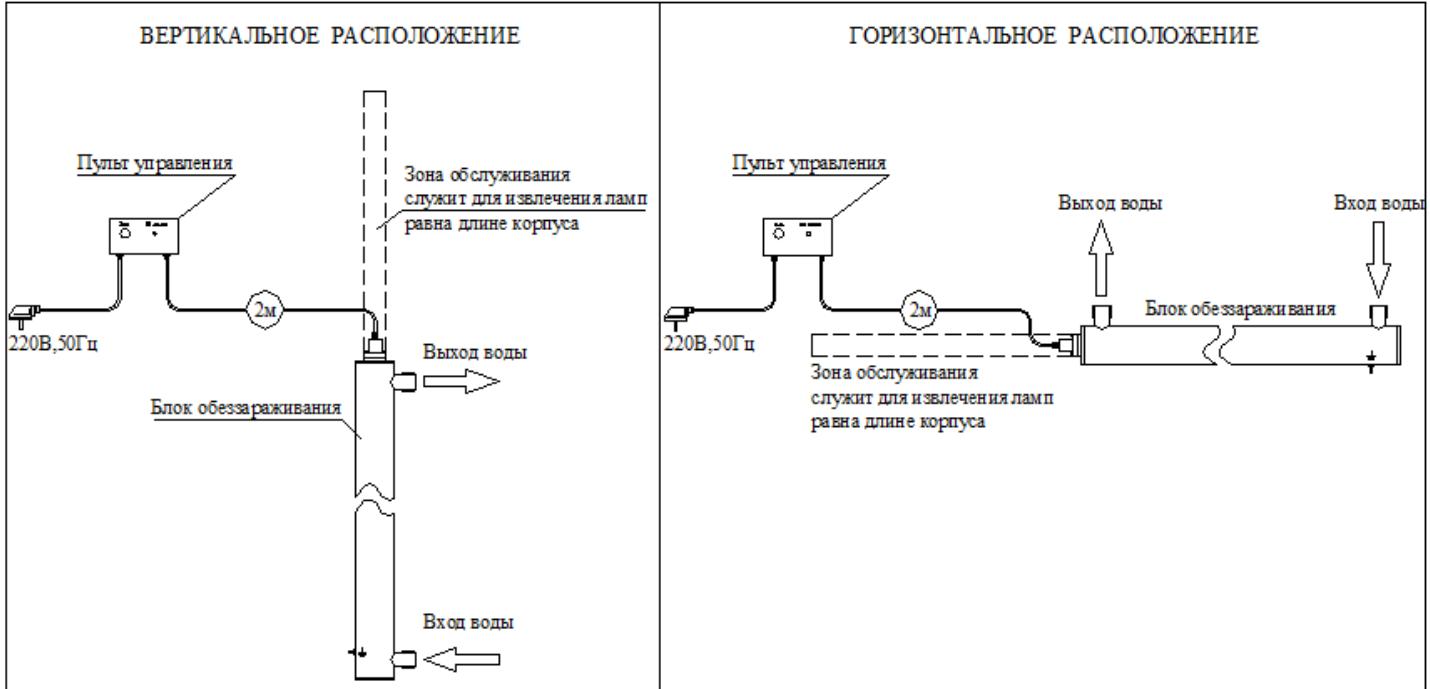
Общий вид установки типа «ОДВ» расположение установки
